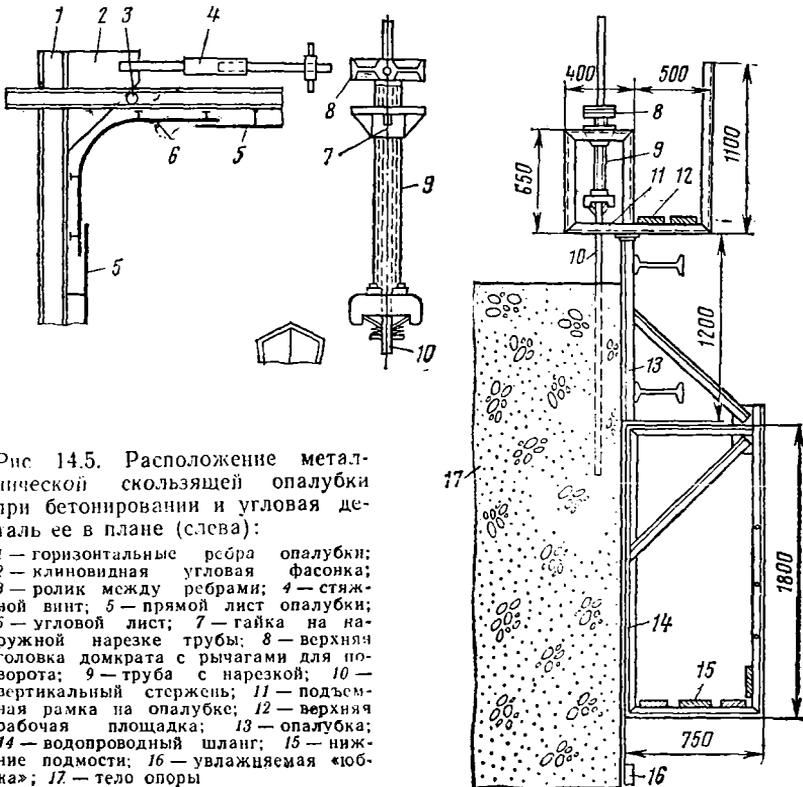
Расположение металлической скользящей опалубки при бетонировании и угловая деталь ее в плане (слева):
